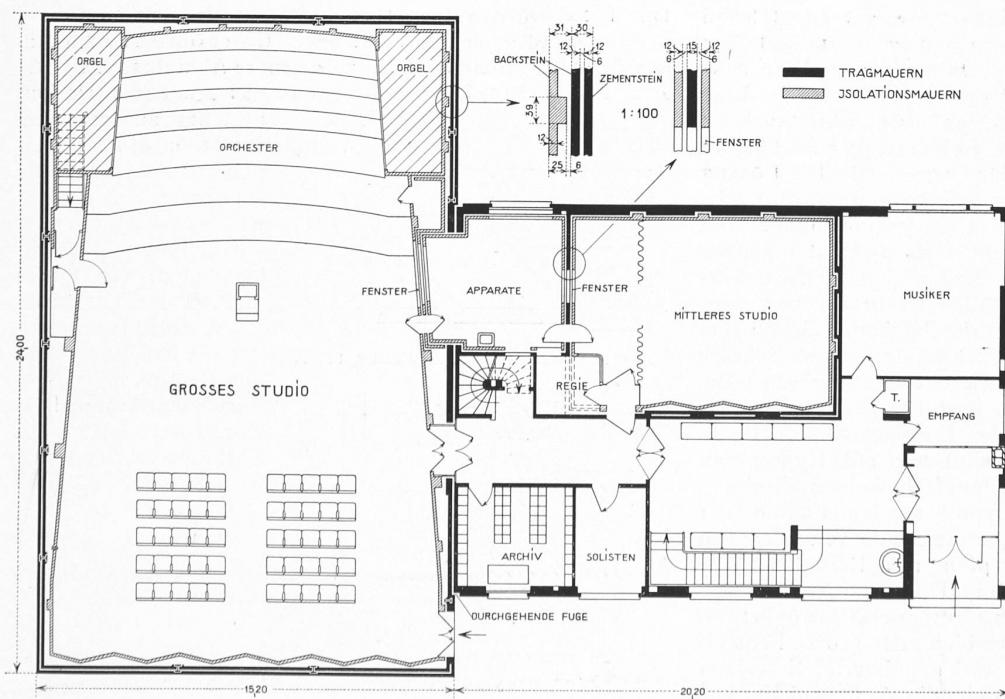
Grundriss, bzw. Horizontalschnitt in Hauptgeschoss-Höhe, 1 : 250. — Tragwände schwarz, Schallwände schraffiert.
